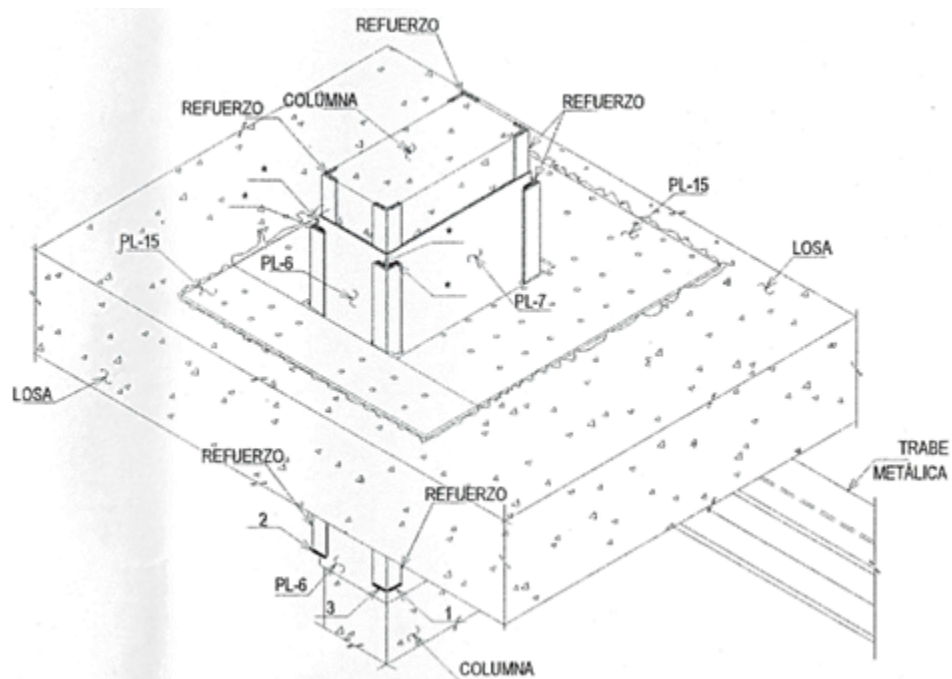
Detalle de las uniones del encamisado y placas en los extremos superior e inferior de las columnas.
